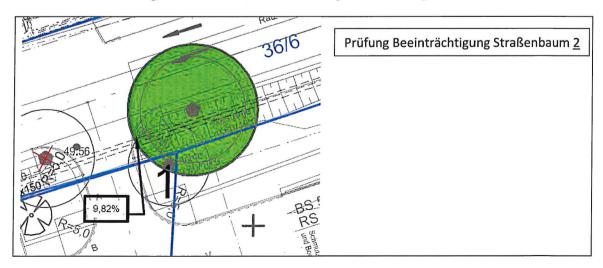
Straßenbäume Rodung, Quelle Auszug Lageplan Sichtweiten iBl Schwerin 06/22
